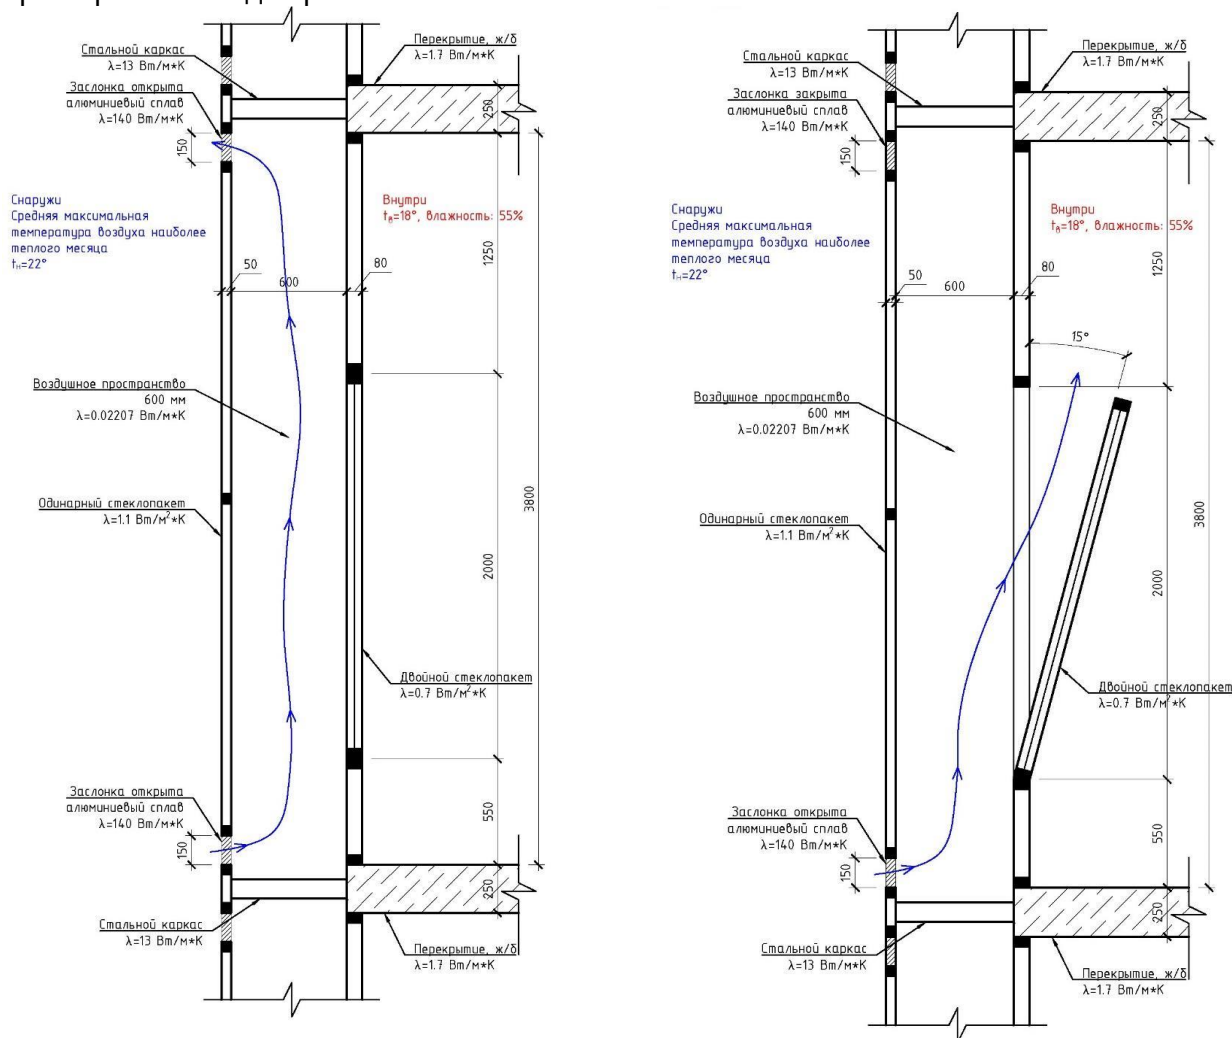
Расчетные схемы Closed cavity facade, модель 2 и 3
